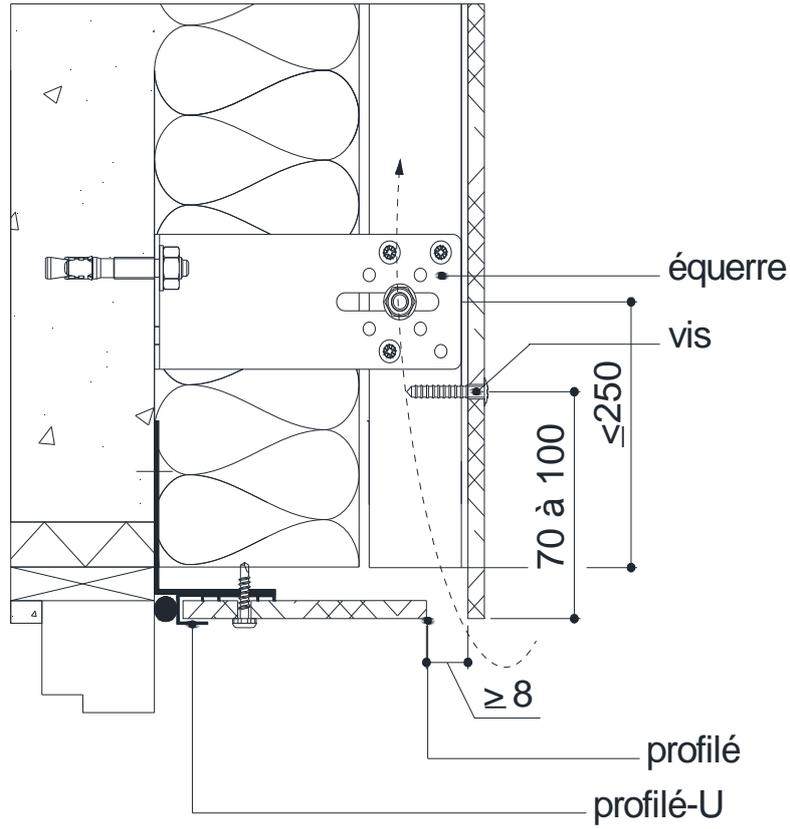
Détail linteau sur ossature bois (cote en mm)
